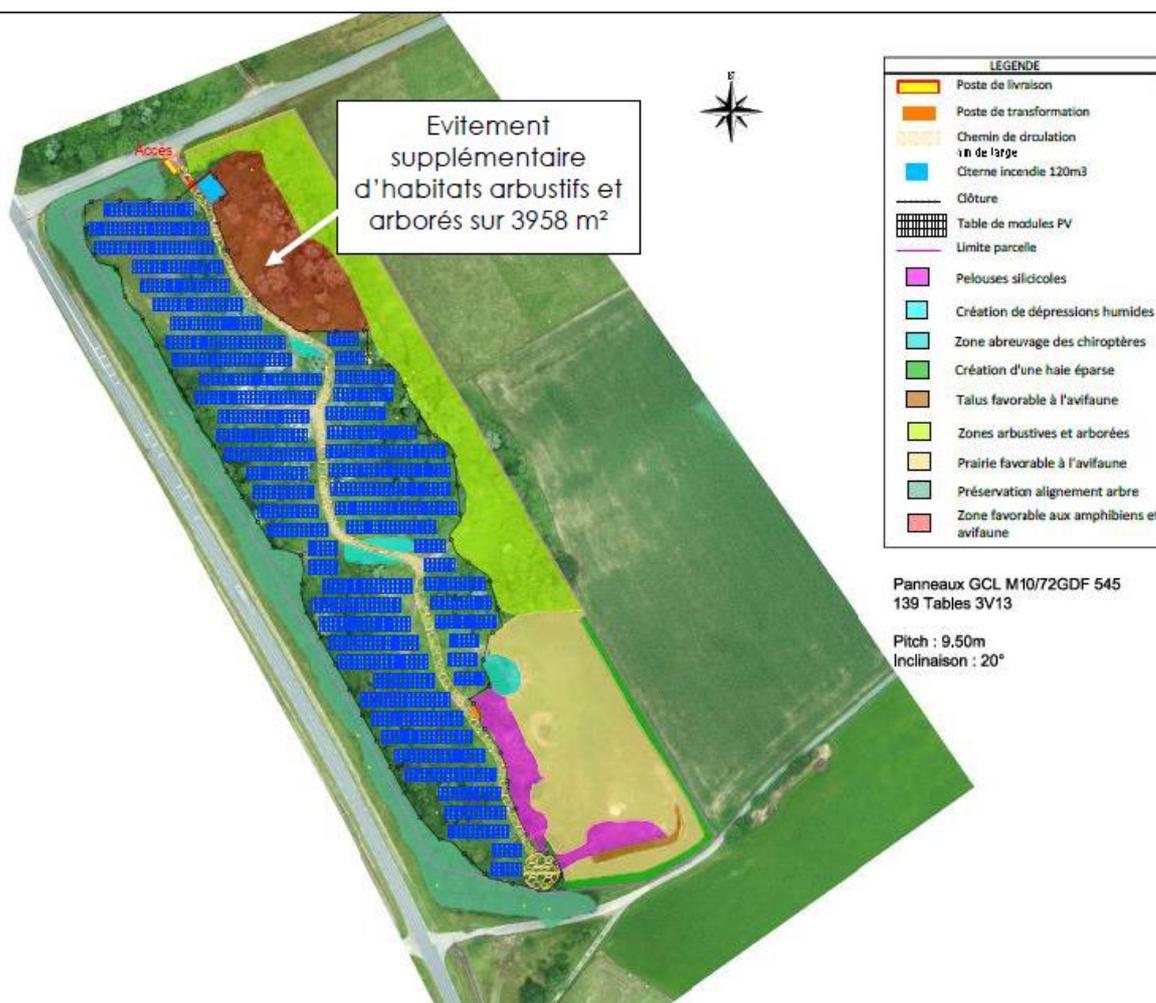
Variante n°4 du plan d'implantation (source : Générale du Solaire)
